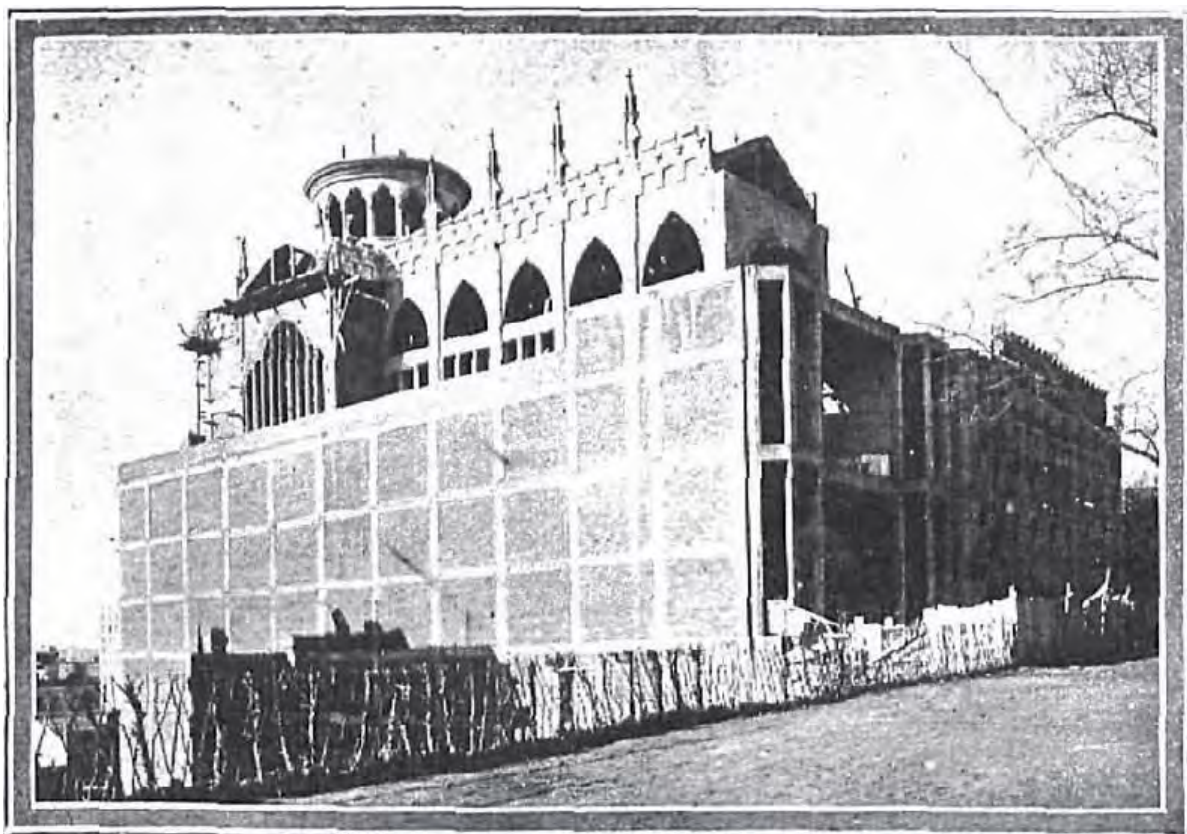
La basílica de Santa Teresa en construcción, con la estructura de hormigón de la fachada aún sin revestir. Fotografía de Cortés publicada en *Nuevo Mundo*, Año XXXIV, n° 1.745, 1 de julio de 1927.
